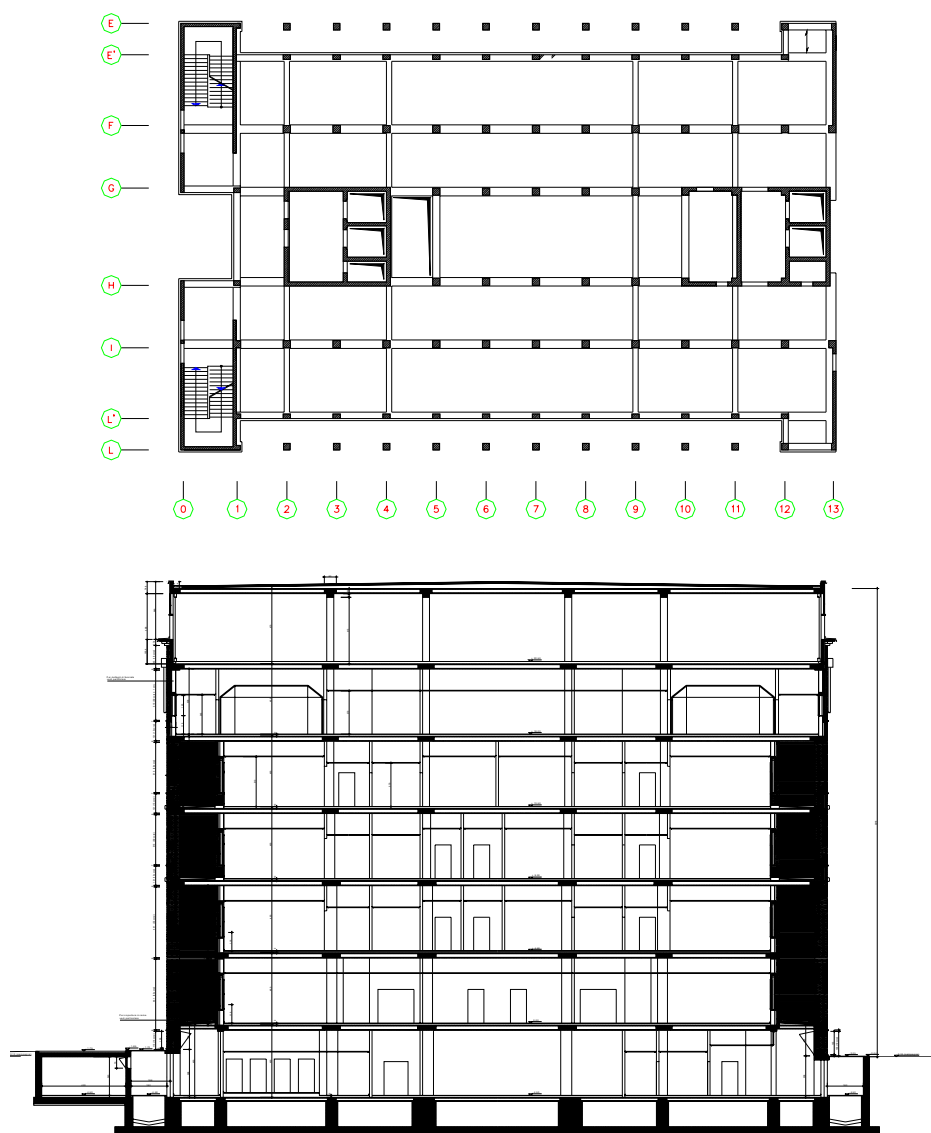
Pianta e Sezione dell'ospedale S. M. Nuova oggetto della sperimentazione dinamica.
